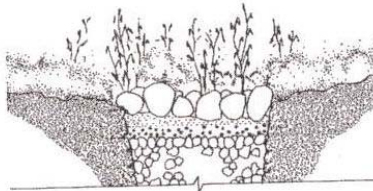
c: Alternativas de cubiertas. Piedras y rocas en jardín de plantas con capas filtrantes.
